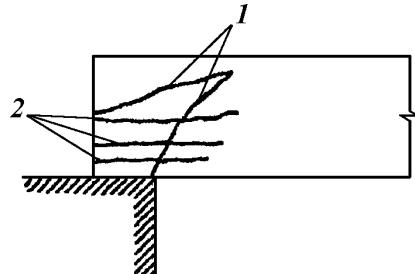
, б. Трещины в опорной части предварительно напряженного элемента: 1 - при нарушении анкеровки напряженной арматуры; 2 - при недостаточности косвенного армирования сечения на действие усилия обжатия
